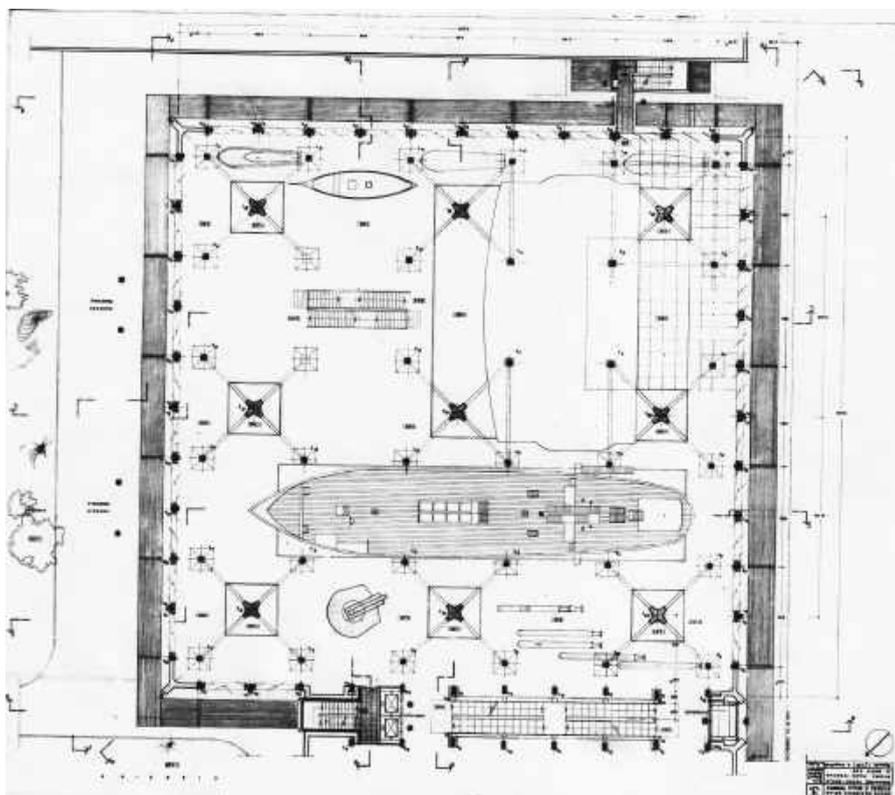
Padiglione Aeronavale, pianta piano terra, soluzione realizzata
